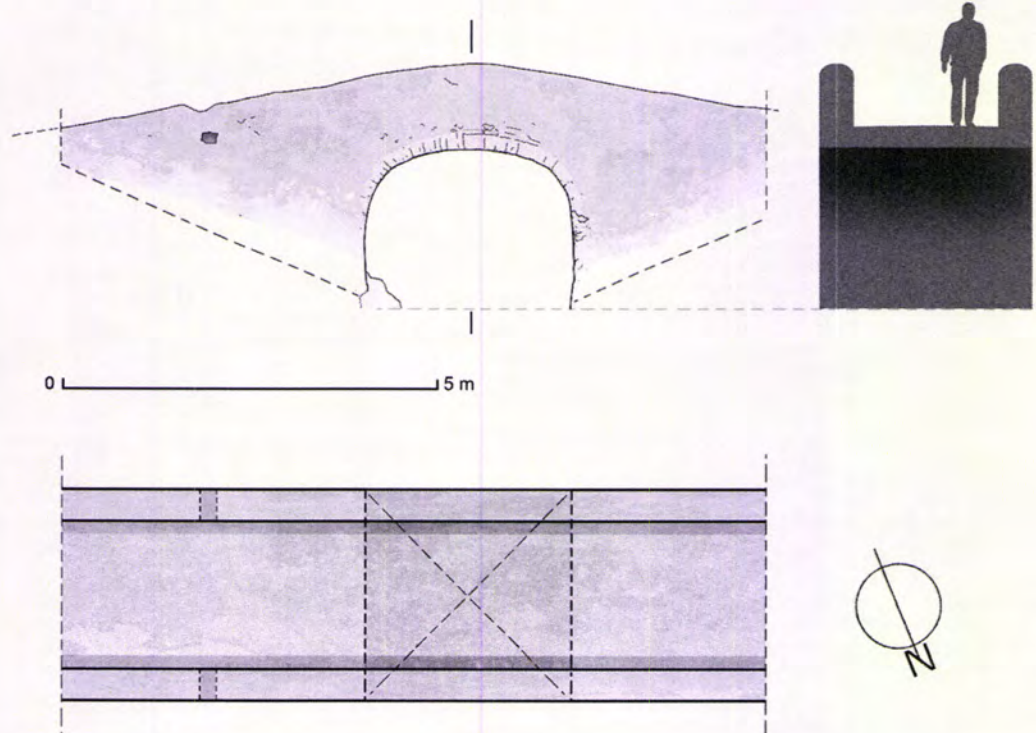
Alçado e planta da ponte ao “Cano Alto”
